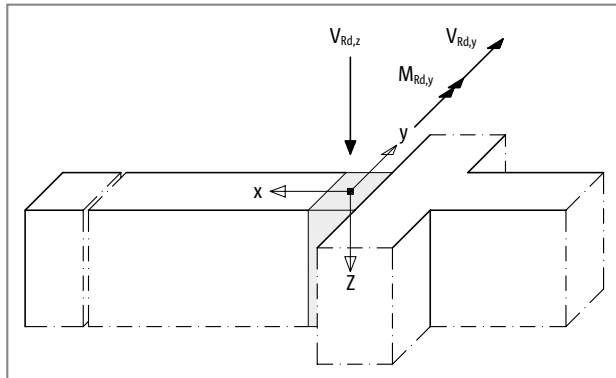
Schöck Isokorb® T Type W : Convention relative aux signes de dimensionnement
